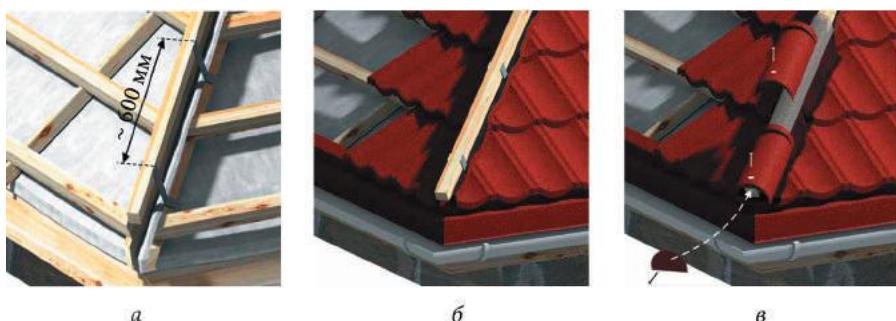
Устройство ребра: *а* — крепление конькового бруса; *б* — подрезка панелей; *в* — крепление коньковых элементов
